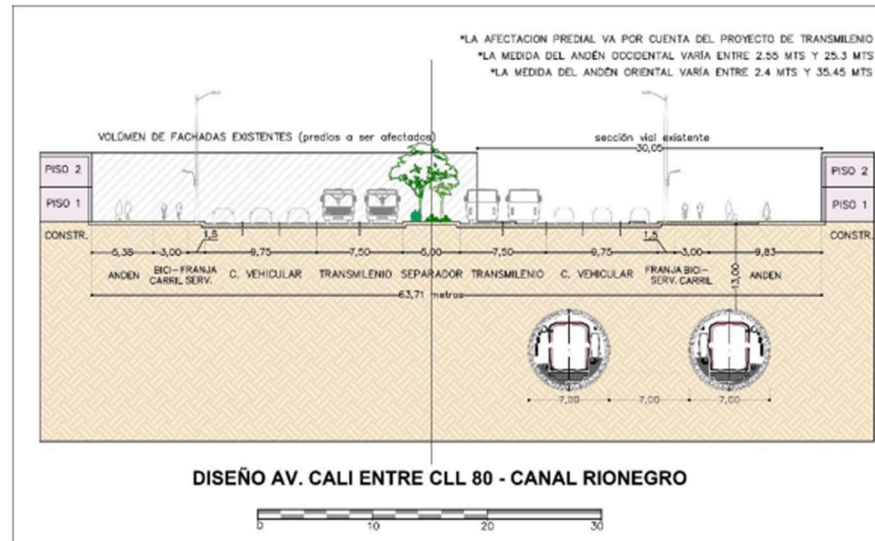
Perfil vial definido para Av. Cali (entre calle 80 y Canal Rionegro).
